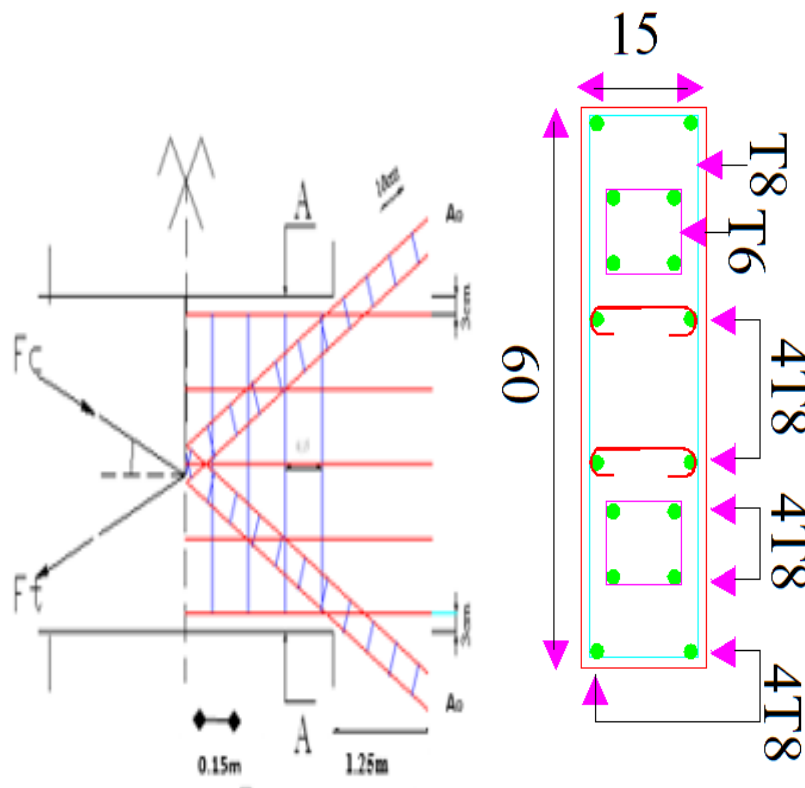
Ferrailage du linteau (L2, L4 ,L6, L8)
